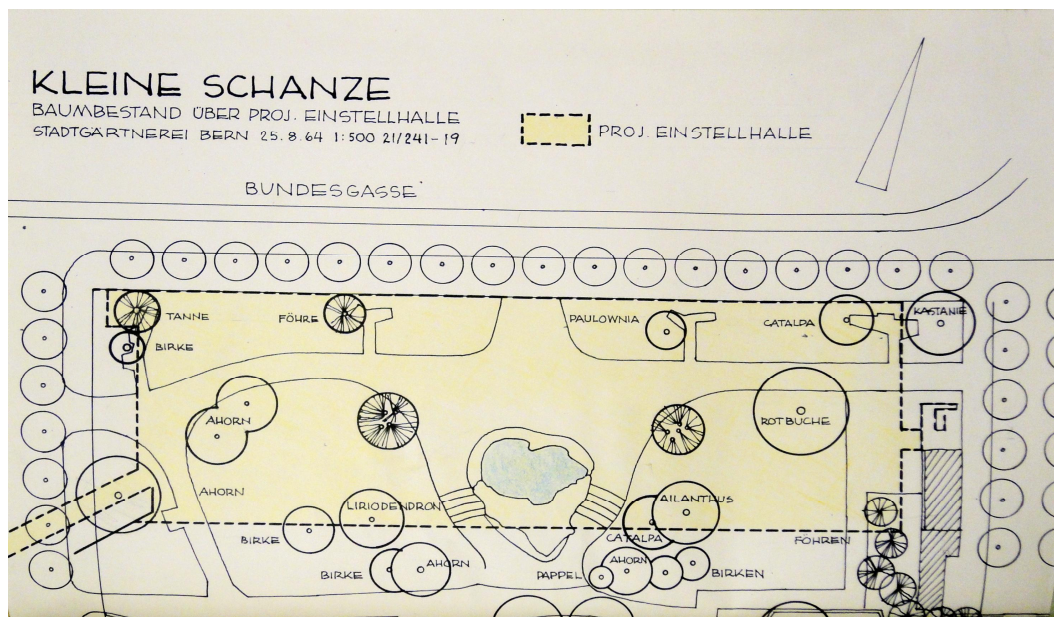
«Kleine Schanze : Baumbestand über proj. Einstellhalle : Stadtgärtnerei Bern» (25. Aug. 1964). Der im Text beschriebene Baumschutzplan der Stadtgärtnerei wird unterlegt mit dem Grundriss der projektierten Tiefgarage unter dem nördlichen Teils des Steinhauerplatzes (Stand Sommer 1964). Q: Archiv SGB, Kiste 273.
